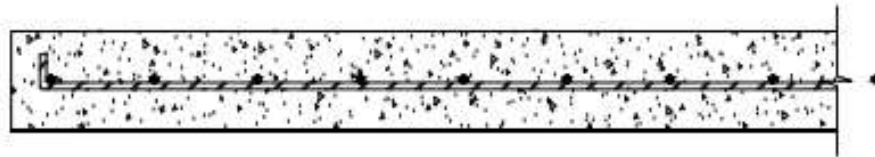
Detalle Corte de Losa Maciza. *Fuente:* Autora (2023)
